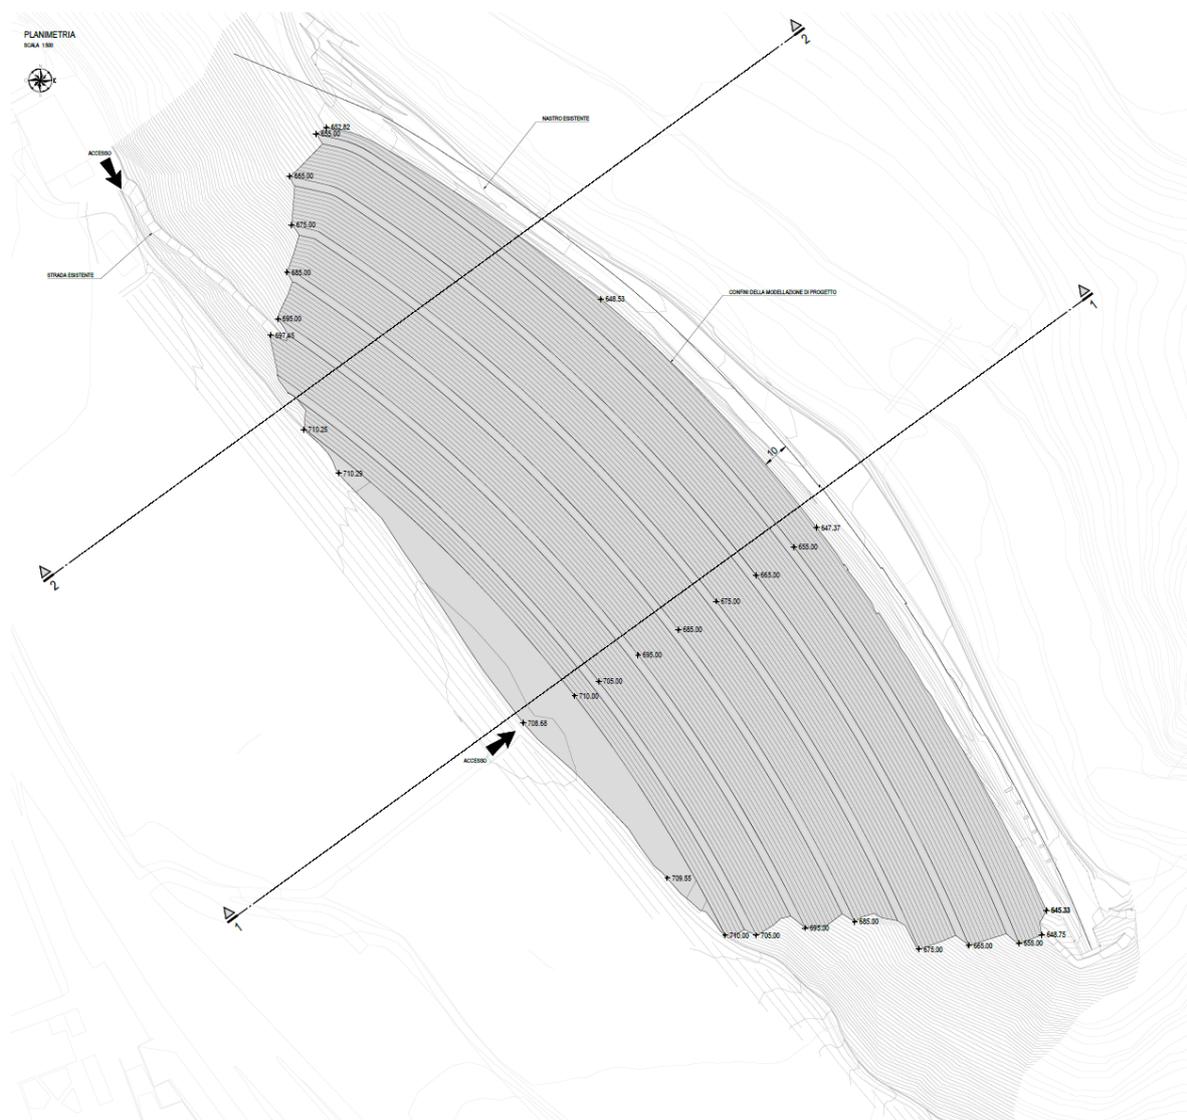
Vista in pianta sito Unterplattner con ubicazione delle sezioni di analisi
